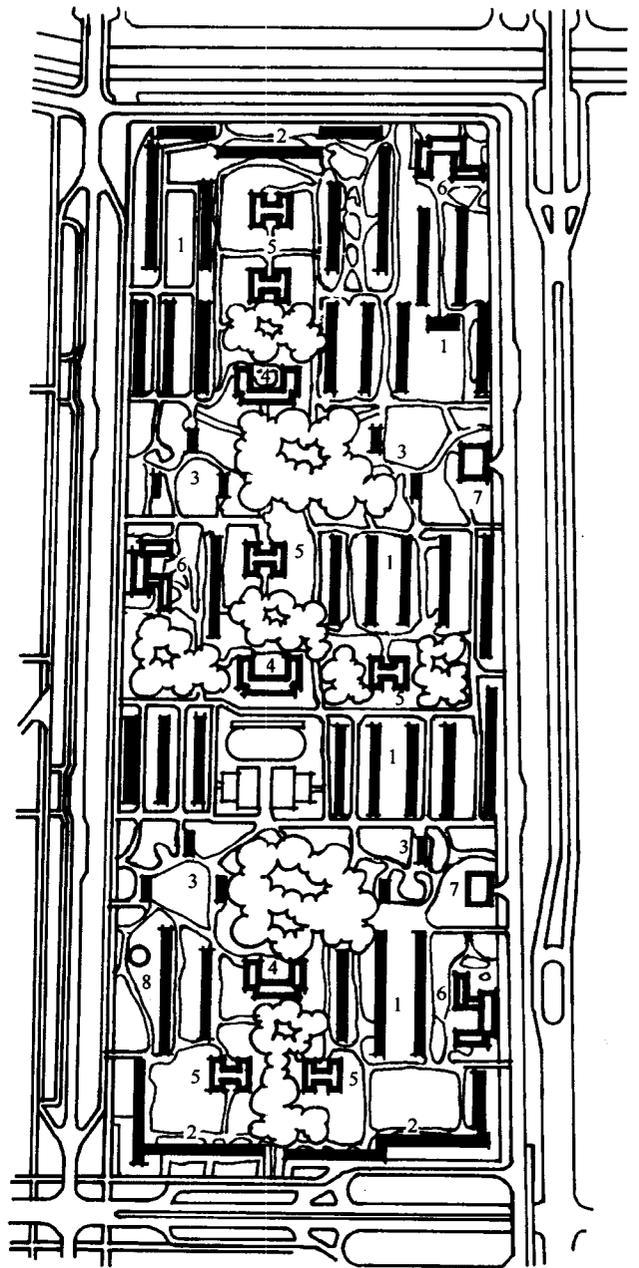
列宁格勒加加宁大街 6 号扩大街坊规划平面图
